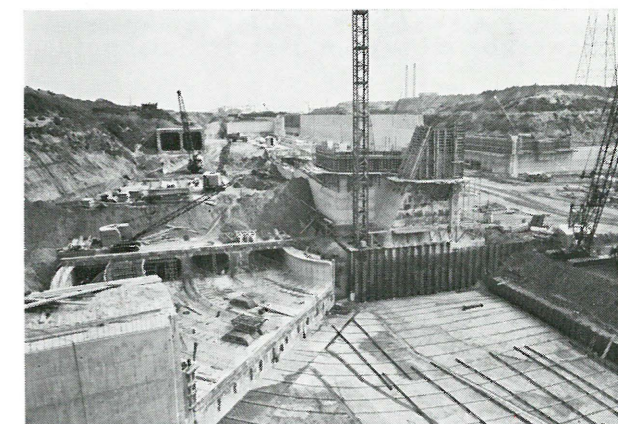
Uitvoering van de afvoerduiker, gedeelte tussen inlaat aan de dokkant en de normale sectie (links boven).
